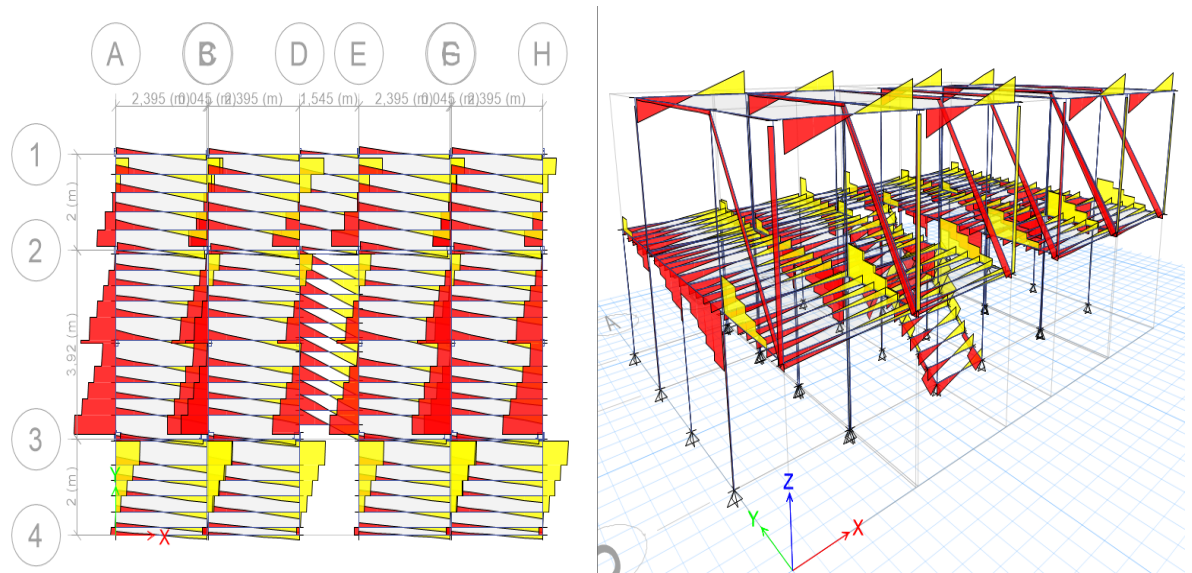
Diagrama de corte. Vista en planta y perspectiva
